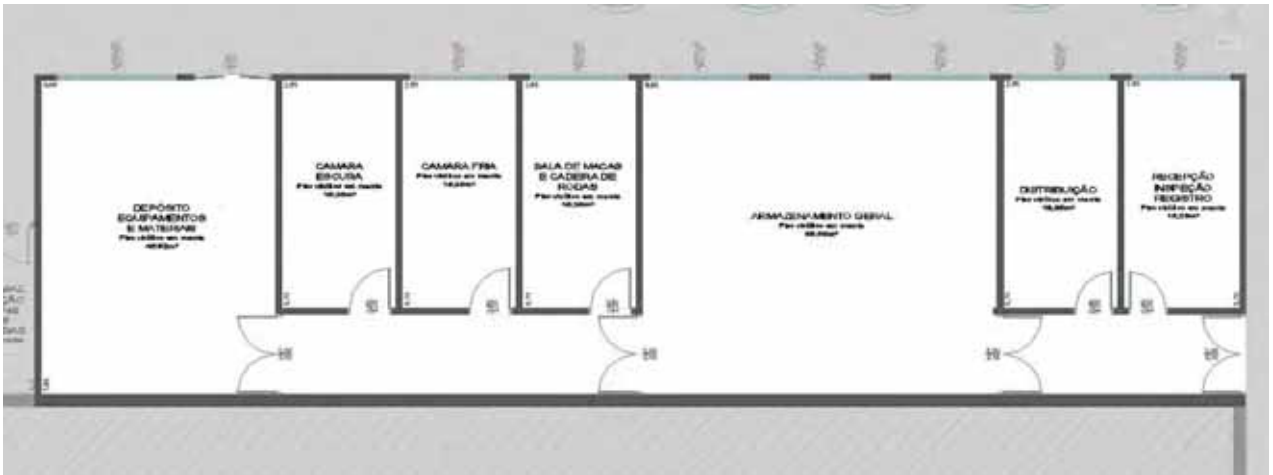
Planta da central de materiais e equipamentos, sem escala.
